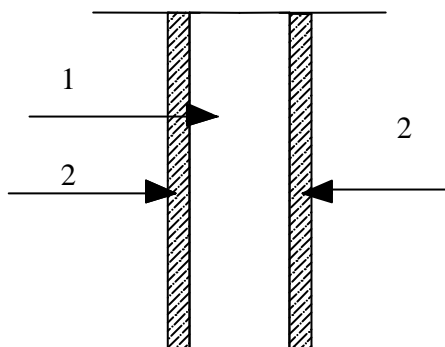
Coupe transversale du mur intérieur (brique de 10 cm d'épaisseur)
